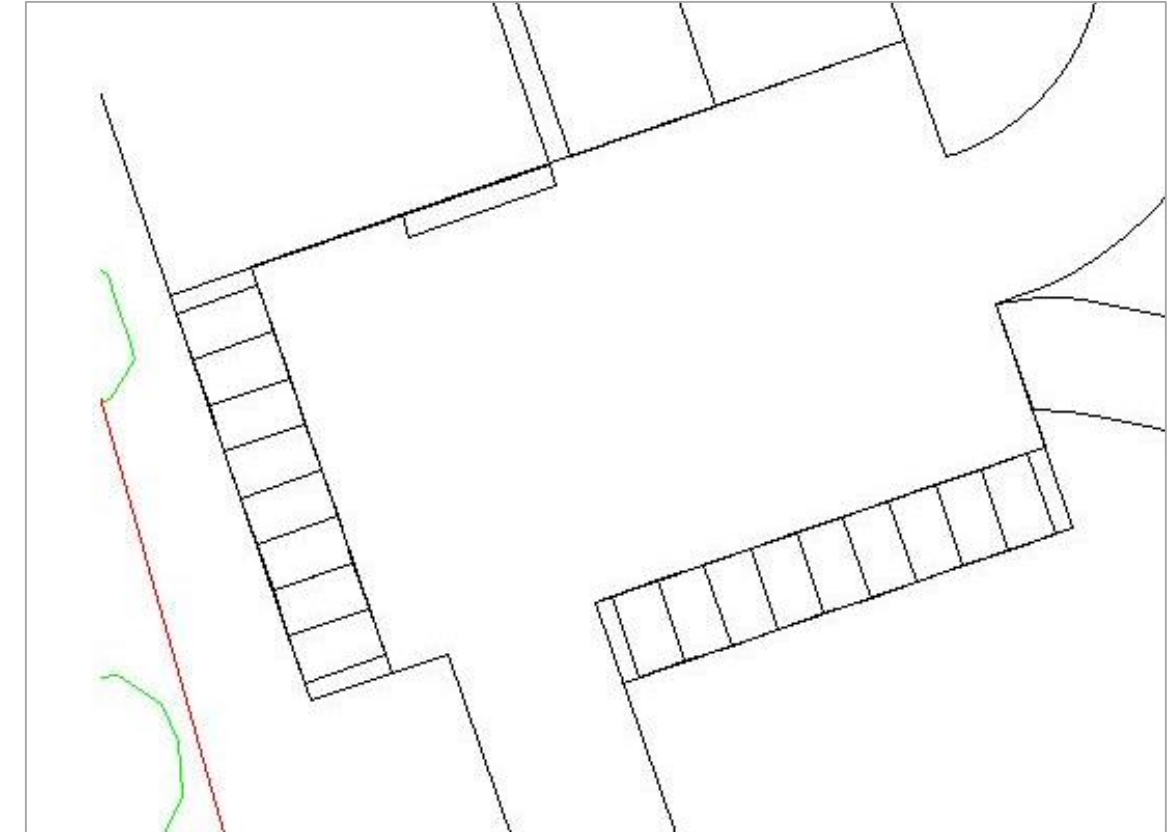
Zona de aparcamiento (Fuente: AutoCAD)
